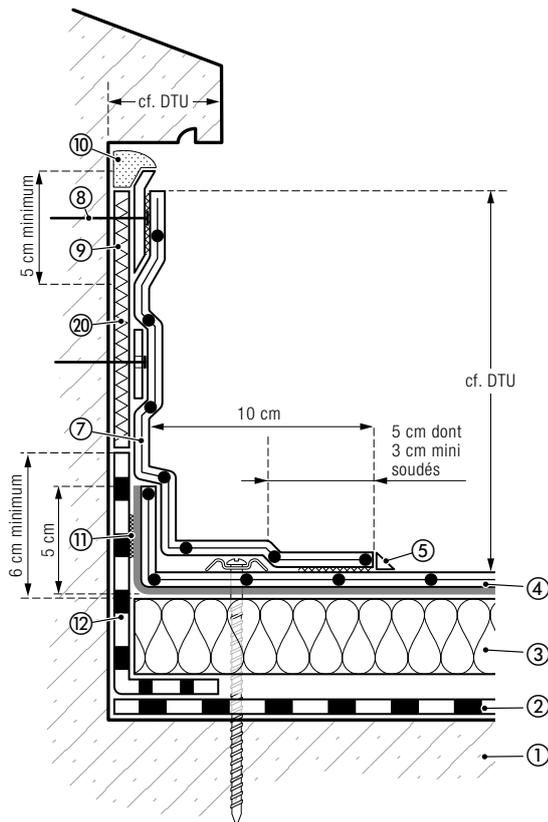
Relevé d'étanchéité libre de hauteur ≥ 200 mm, et avec pare-vapeur bitumineux sur maçonnerie
